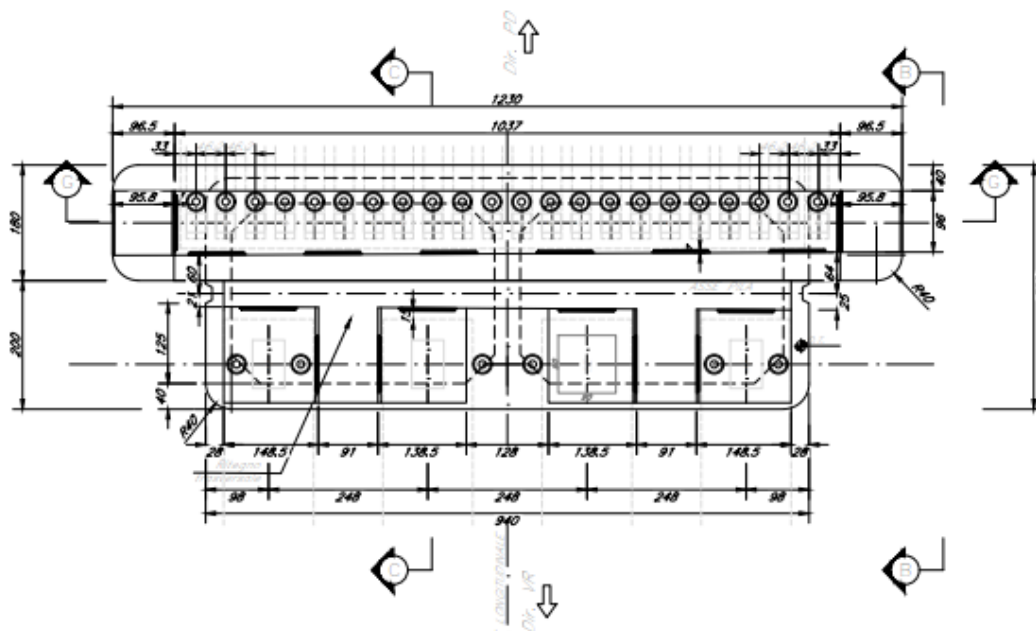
Sezione trasversale pila (lato Travi Incorporate)
